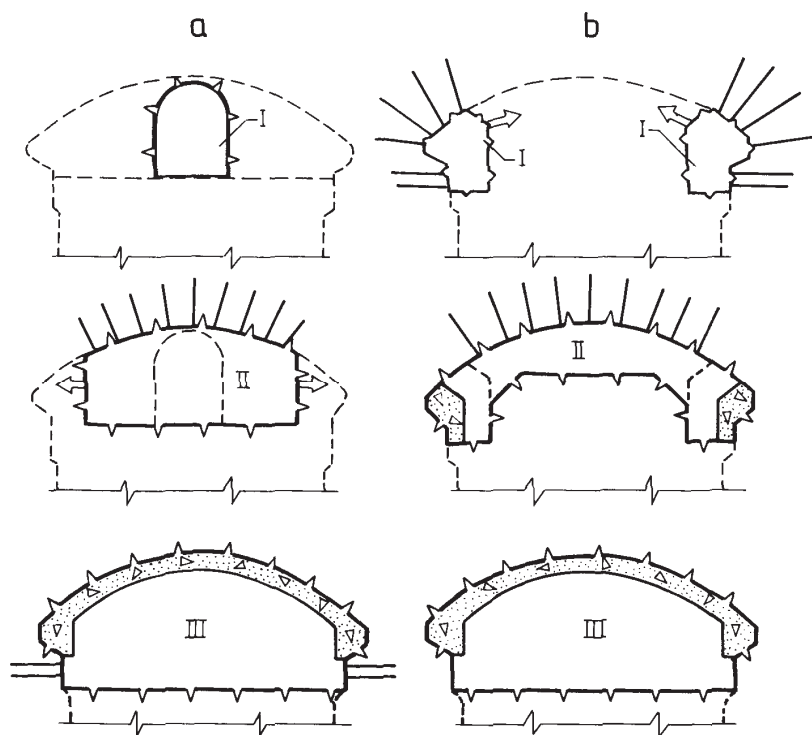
Faze de execuție la excavarea și sprijinirea bolții:
